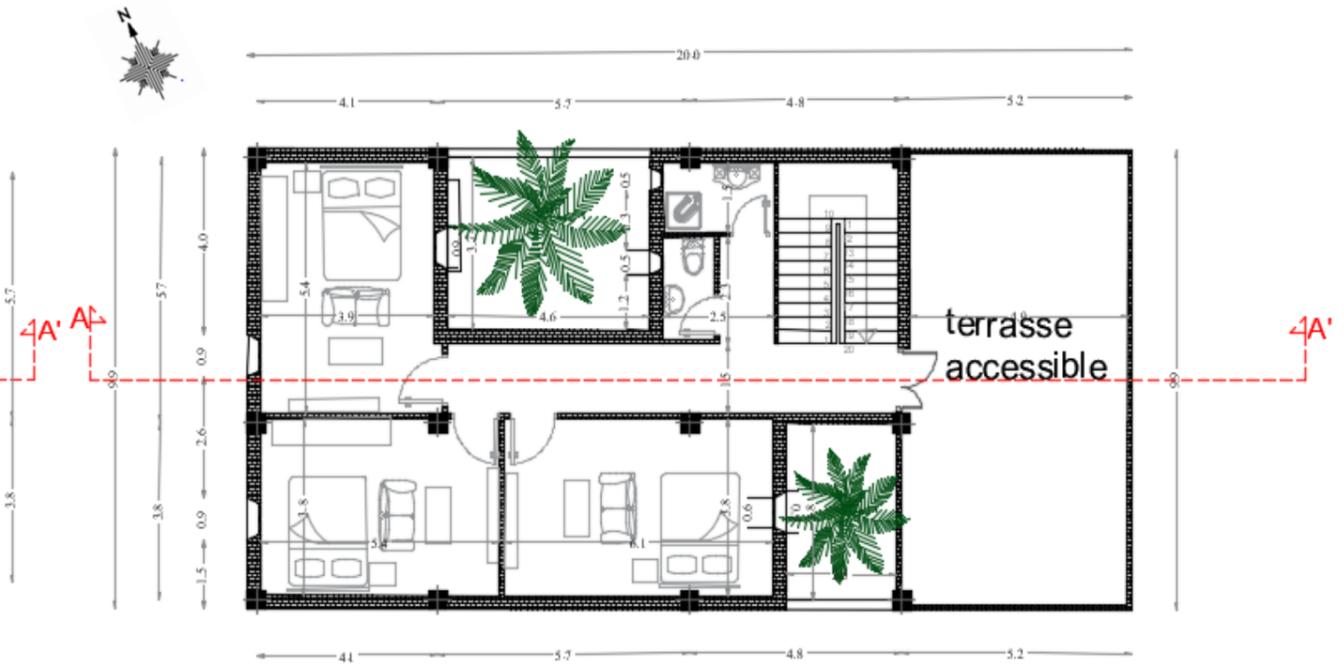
PLAN R+1 LOGEMENT TYPE2;
